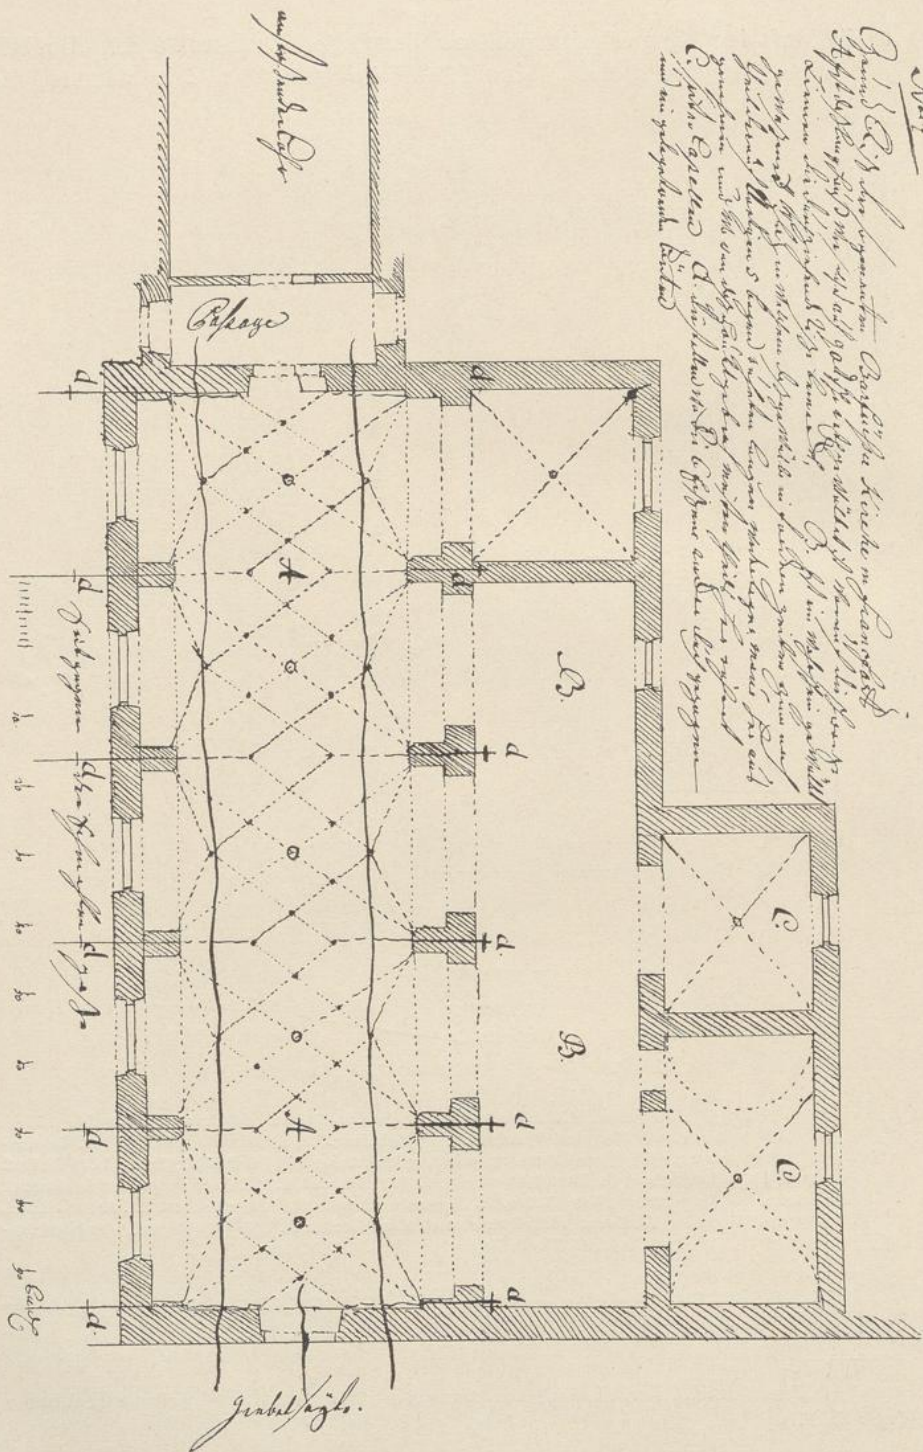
Ehemalige Barfüßer-Kirche; Grundriss.
